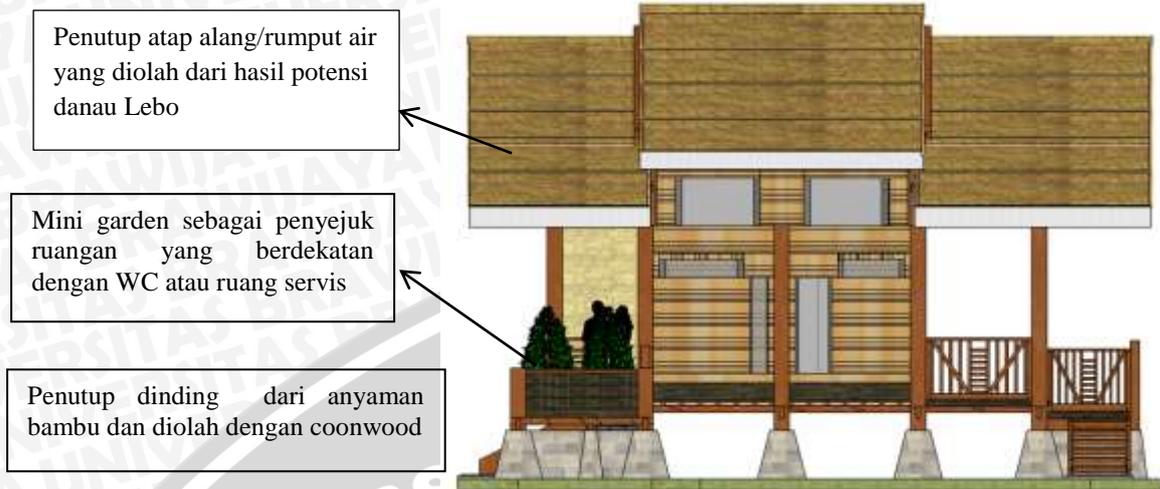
Penataan Ruang Dalam Bangunan Cottage
